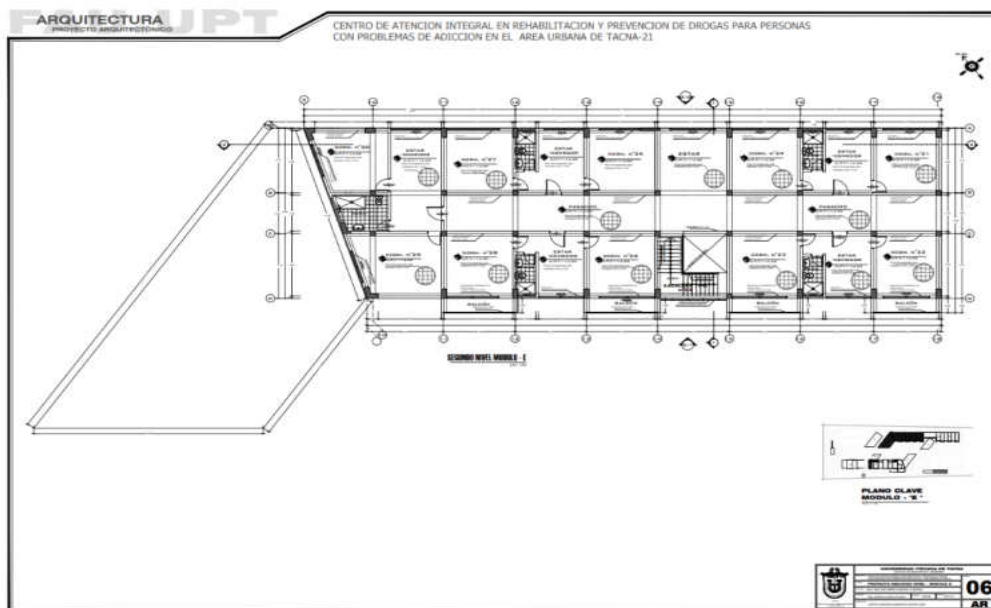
Plano segundo nivel bloque E, fuente elaboración propia.
